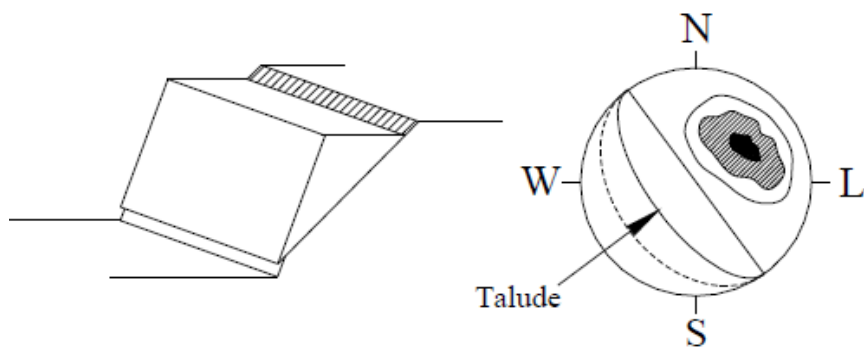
a)– Rotura planar e condições estruturais que lhe dão origem (adaptado de Hoek & Bray,1981).
